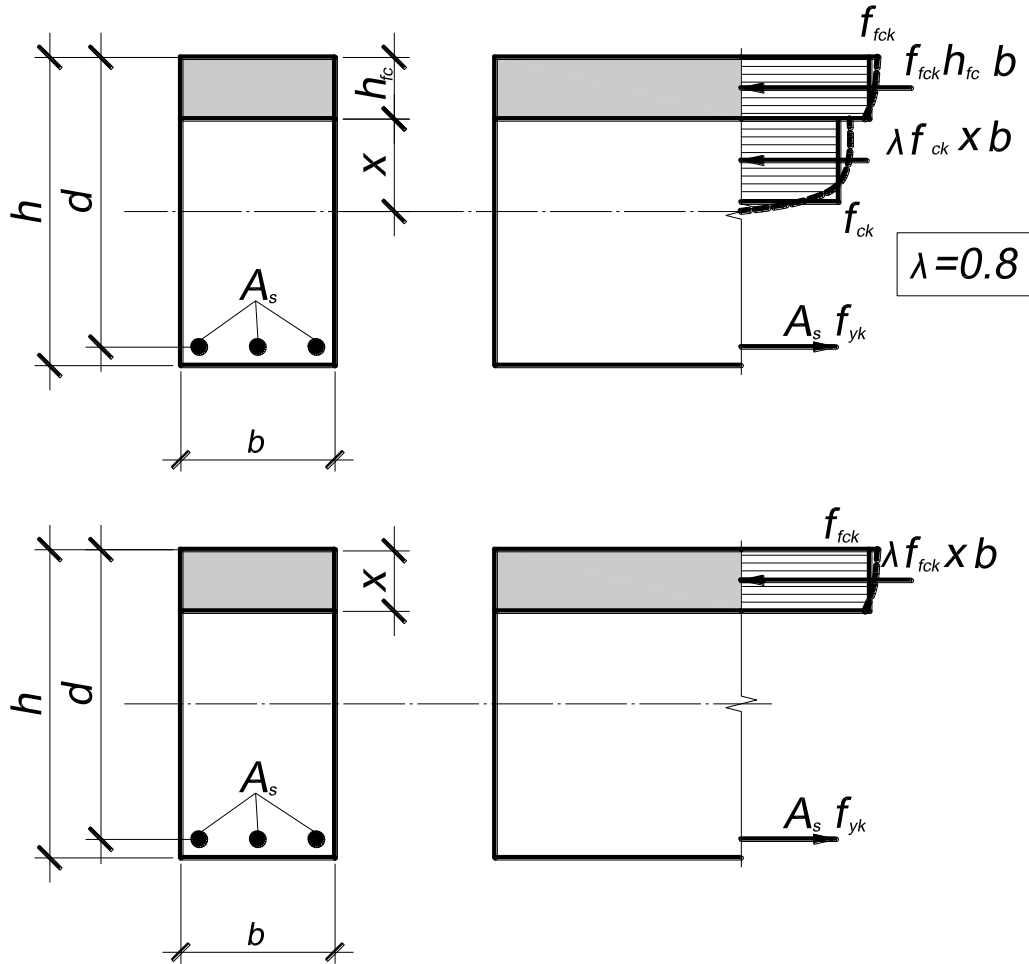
До розрахунку на міцність балки, комплексного поперечного перерізу
